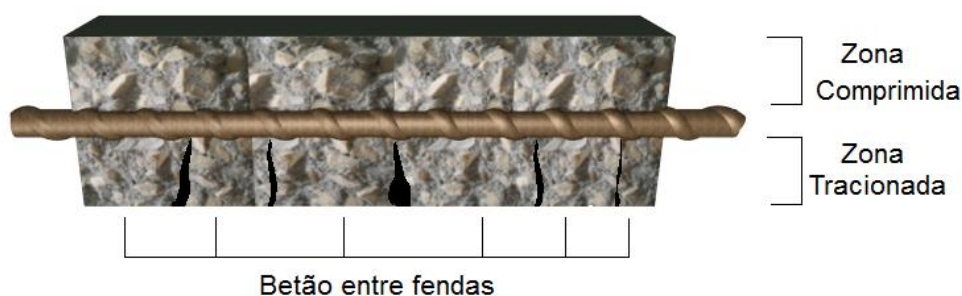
Contributo do betão entre fendas (adaptação Bento, 2013).
